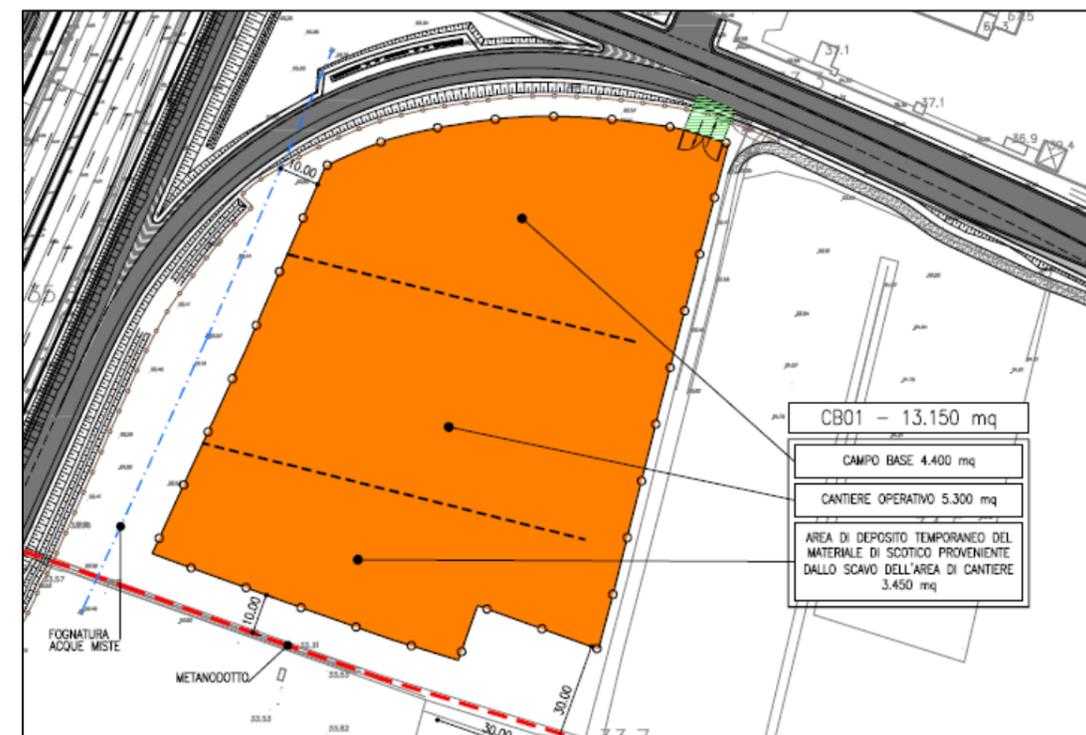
Ubicazione Area Cantiere di Base CB01
